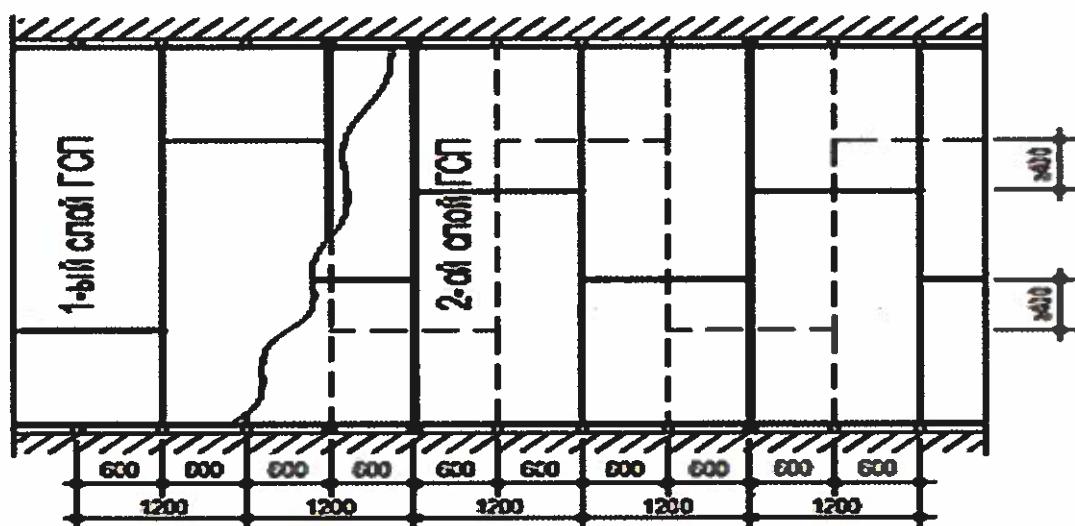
Принципиальная схема раскладки КНАУФ-листов облицовки базовой стены на металлическом каркасе
